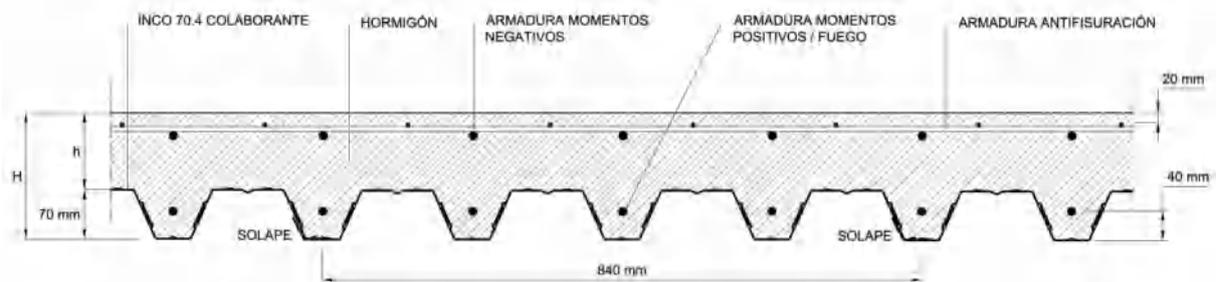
“Disposición de las armaduras de positivos/fuego, negativos y armadura antifisuración”
